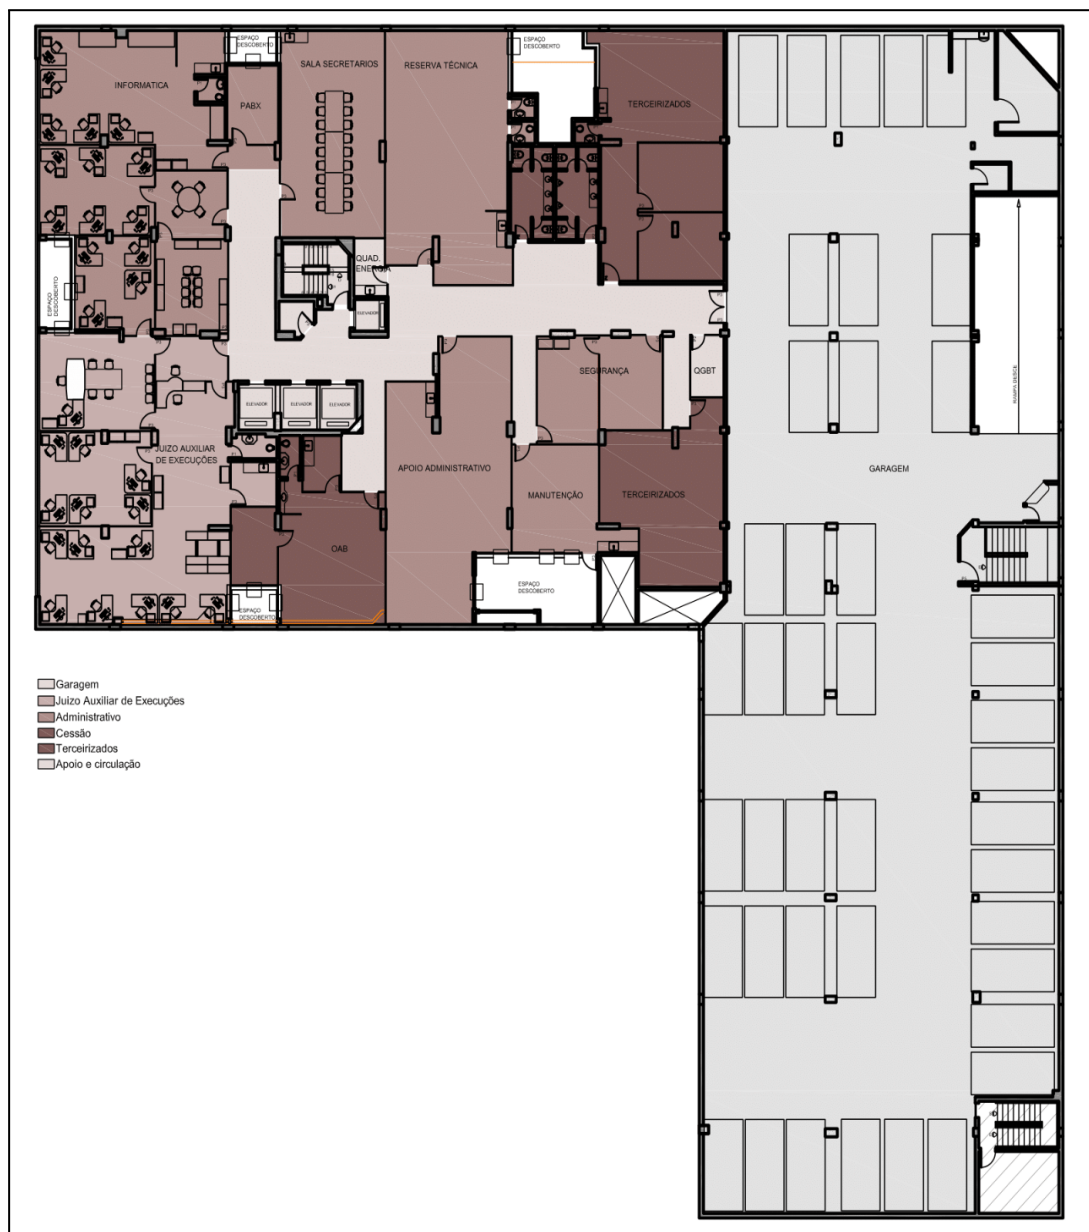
Planta atual do 2º pavimento do prédio da Rua Goitacazes 1475.
